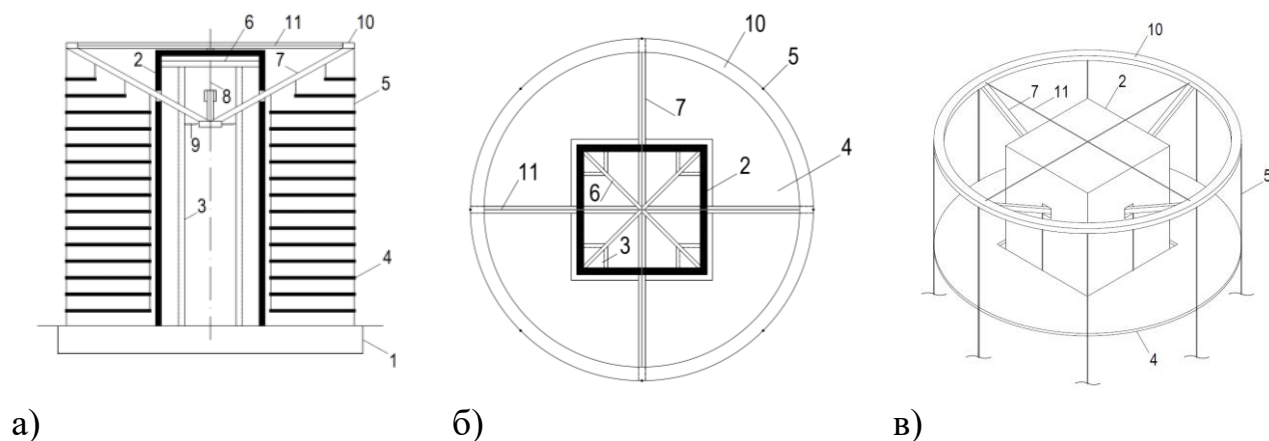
Предлагаемое конструктивное решение здания: а) вертикальный разрез здания; б) план здания; в) аксонометрическая проекция верхней части здания
